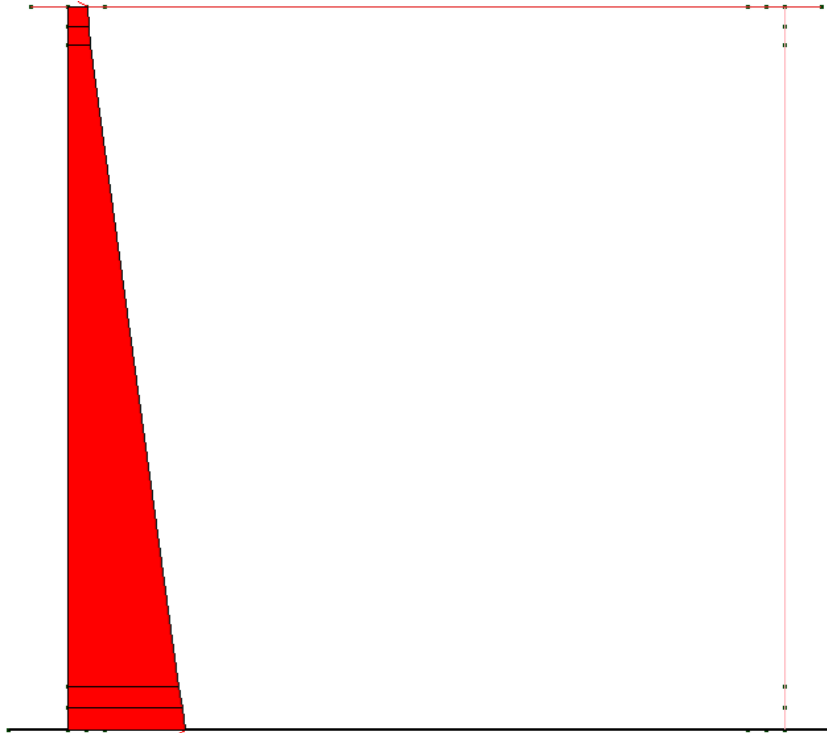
SPINTA ATTIVA DELLE TERRE SUL PIEDRITTO SINISTRO (CDC 5)
